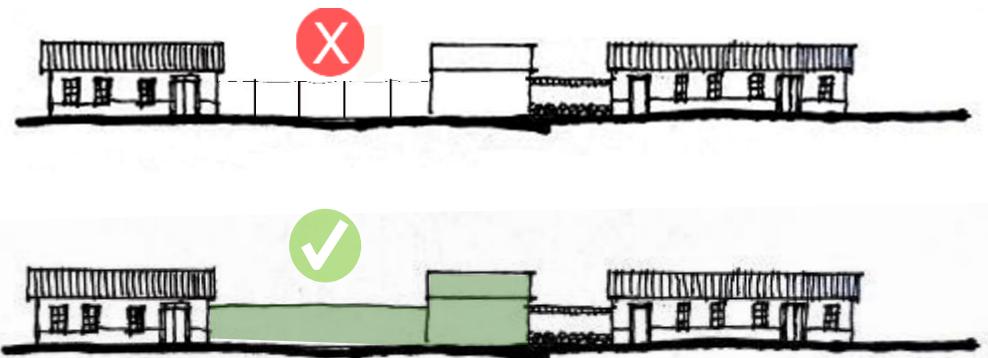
Ejemplo de incorporación de edificación nueva que completa su fachada con cierre perimetral en muro de tierra.
